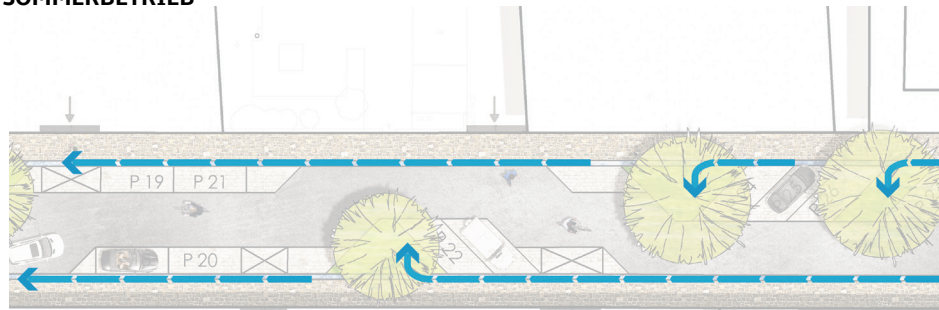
Baumbeteete werden nur im Sommerbetrieb direkt mit Straßenwasser bewässert.
